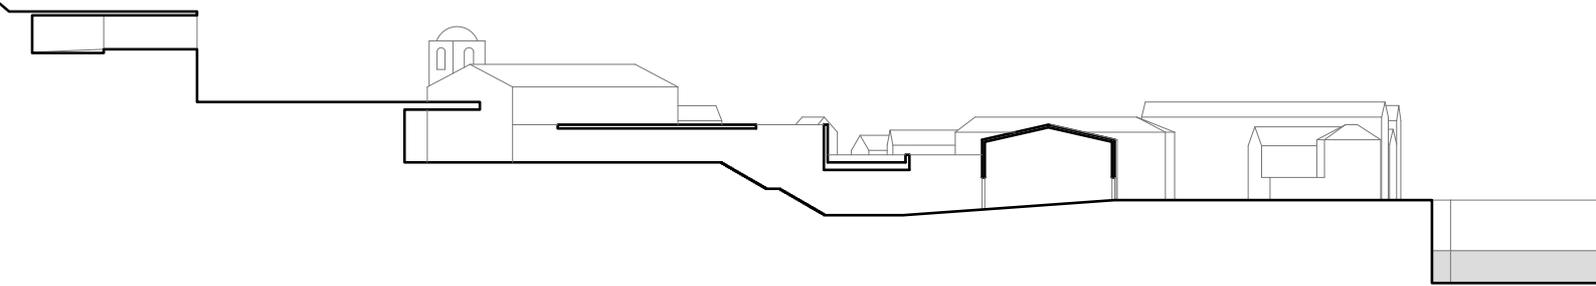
Ribeira. Perfil 06. Praça de Santa Iria. [esc. 1:1000]
